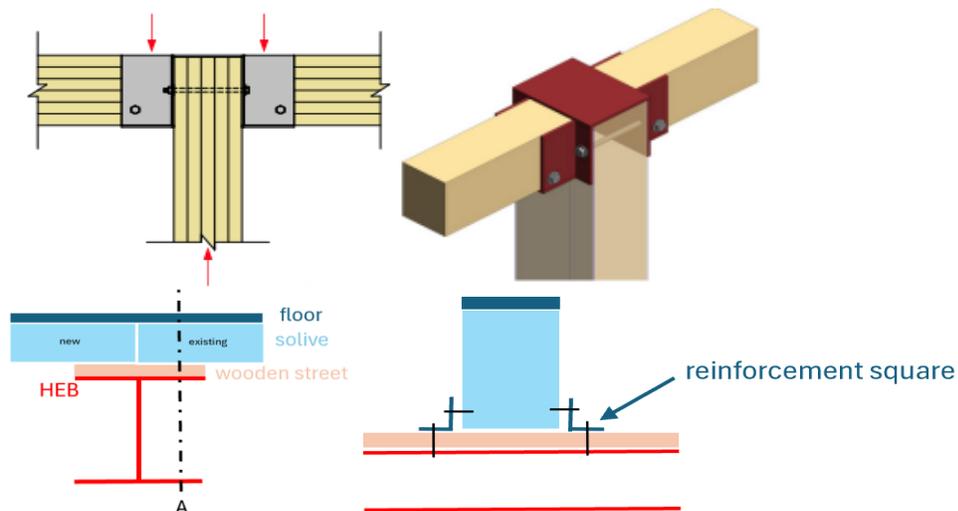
Assemblages à sec bois-bois et bois-acier : poutre-poteau, plancher OSB, voiles CLT.
